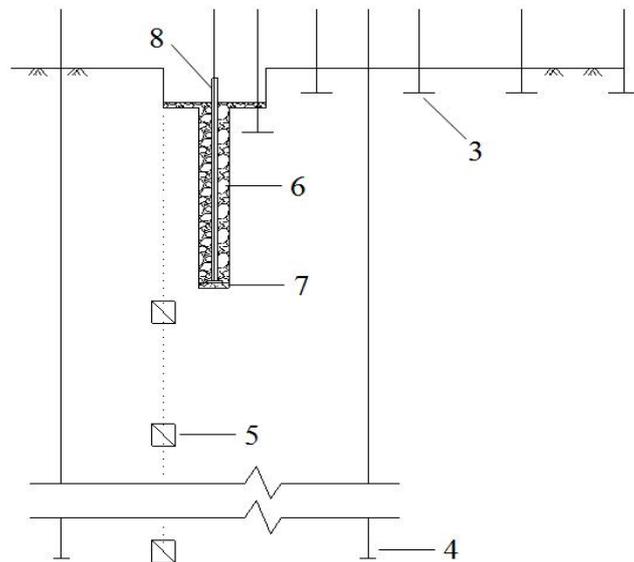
砂井浸水试验各标点布设剖面示意图
